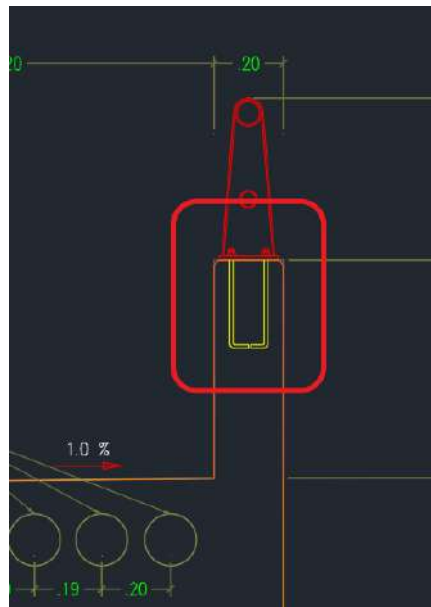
Vista de detalle sección transversal baranda del plano "EST-O2-PT-05-10-r1 – Barandas y Juntas".
